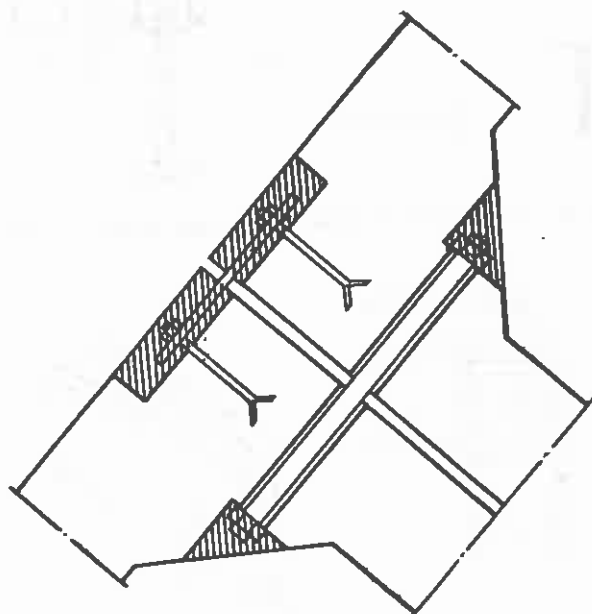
Pormenor de ligação de asna fabricada por partes
